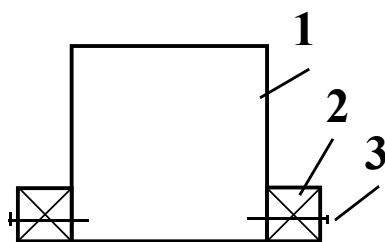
Балка цельного сечения (1), черепной брусок (2) и скрепляющие их гвозди (3)
